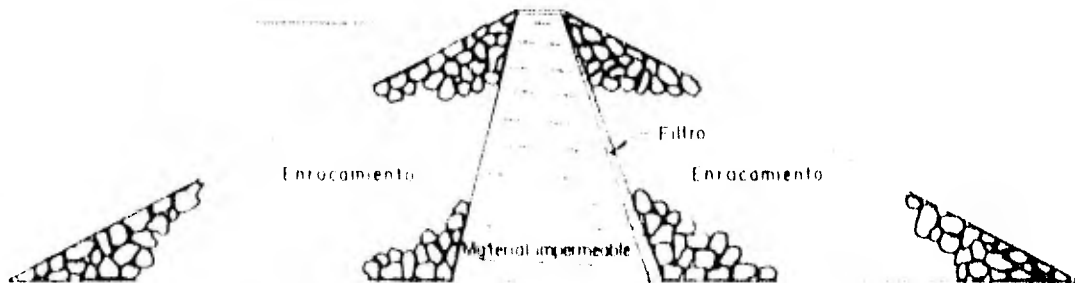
Sección de presa de enrocamiento con núcleo de material impermeable.
